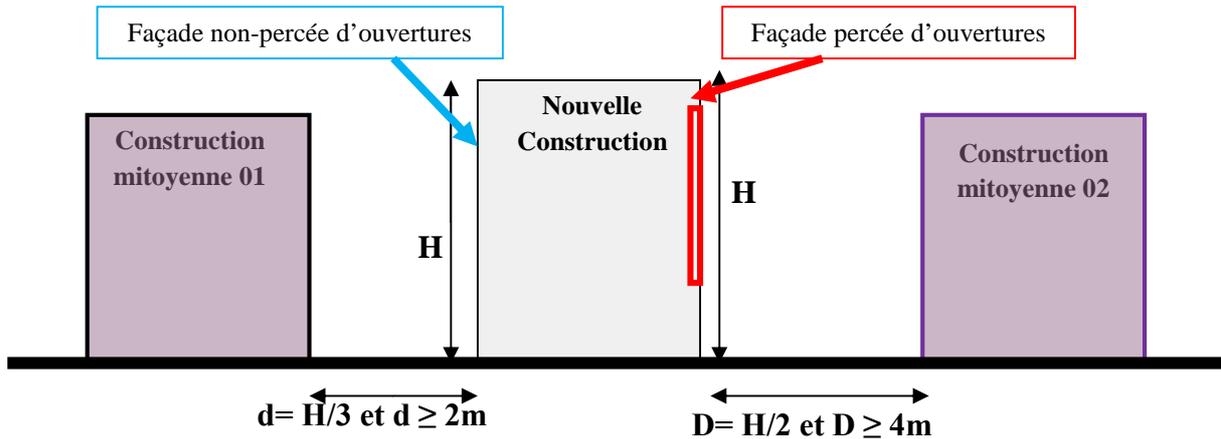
Coupe définissant les règles d'implantation d'une construction par rapport aux limites séparatives. Source : Auteur, 2014.
